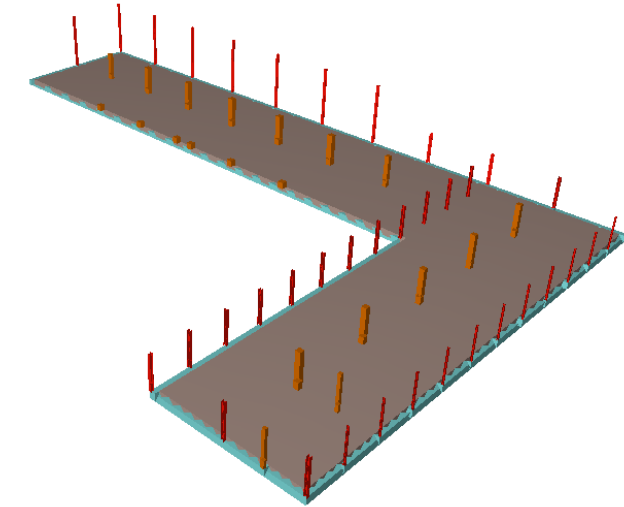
Fase 1 – Ejecución de los pilares de hormigón. Fuente: Propia.
